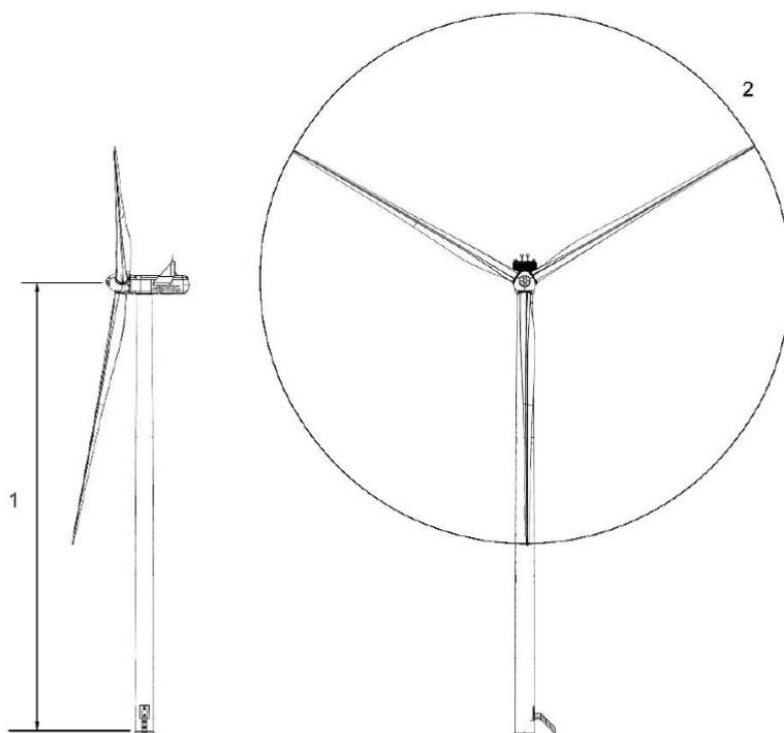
Darstellung der Außenabmessungen – Konstruktion
